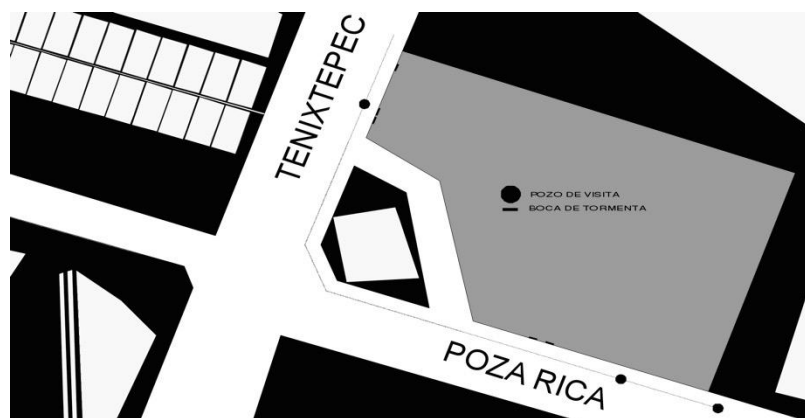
Servicio de drenaje sanitario en el terreno. Fuente: Elaborado por el autor
